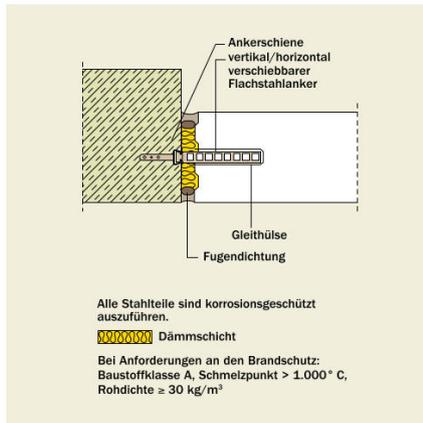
Beispiel für einen gelenkigen Wandanschluss an eine Stahlbetonstütze mit Ankerschienen bei Verwendung von Normalmauermörtel
